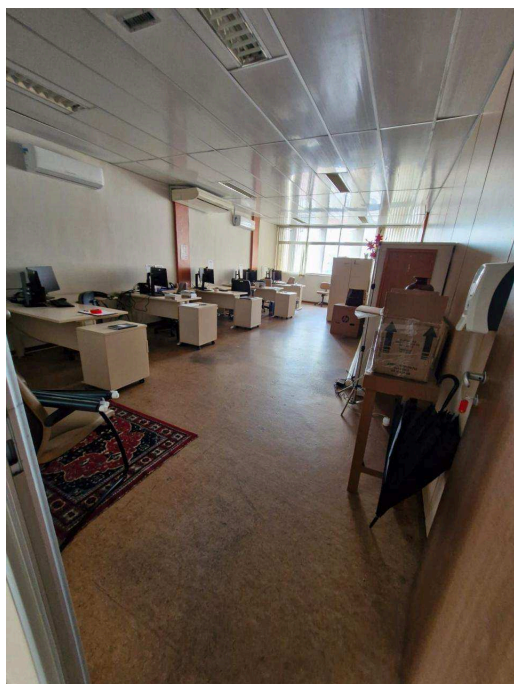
forro modulado em PVC com estrutura de fixação metálica a ser removida.
